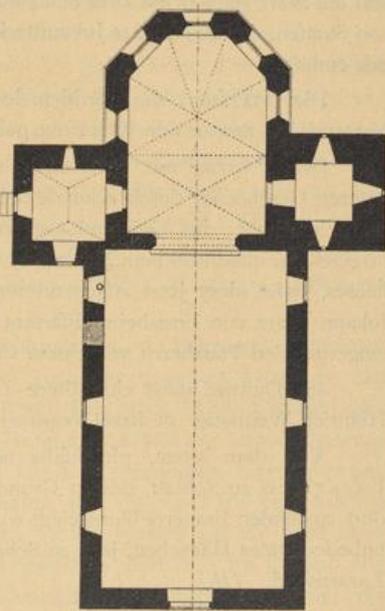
Schlatt. Kirche. Grundriss.
